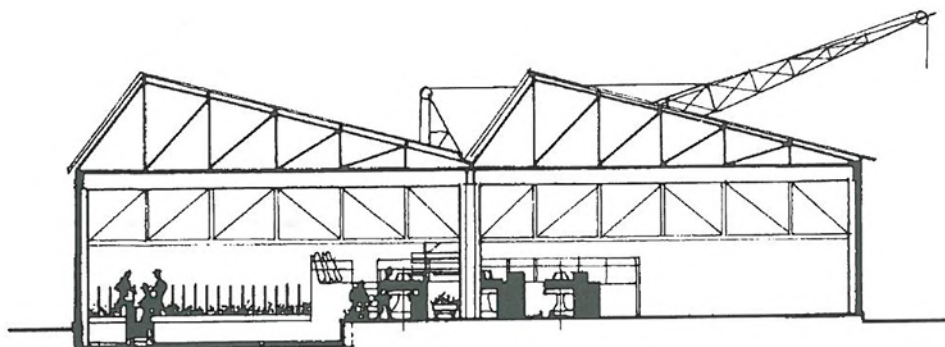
Corte da oficina de 12 a 15 t pelas secções de corte e estribo
